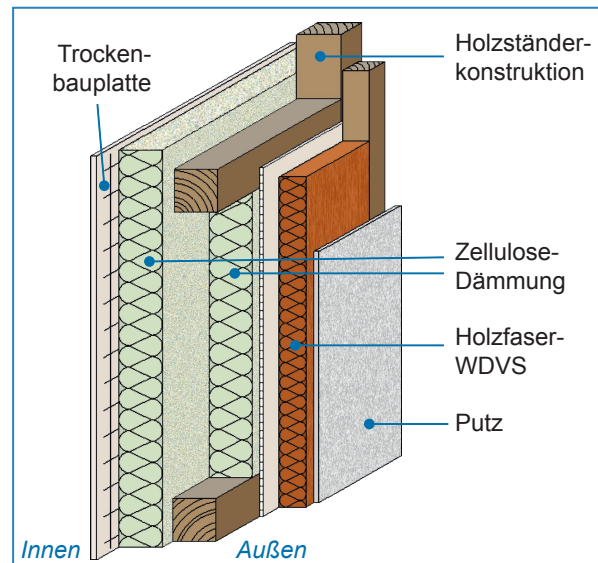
Wandaufbau Holzständerbauweise / Hybridbauweise
